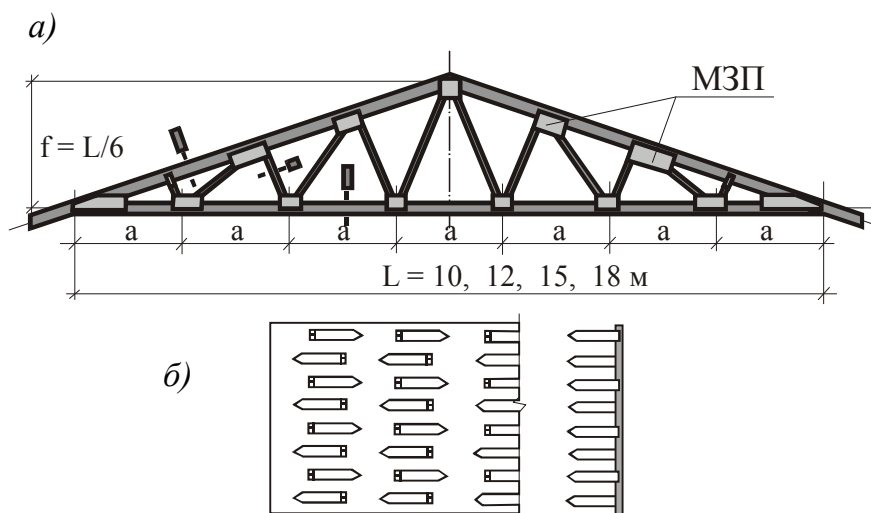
Ферма с узлами на металлических зубчатых пластинах: а – конструкция фермы; б – металлическая зубчатая пластина
